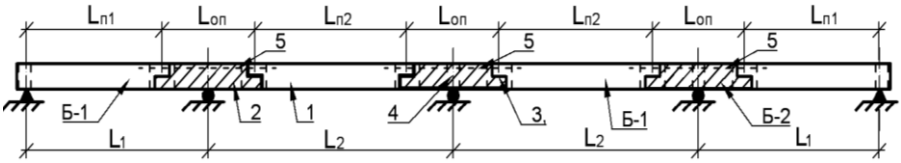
Схема розміщення збірних і монолітних головних балок в нерозрізній прогоновій будові моста: 1 - збірні в прогонах балки; 2 - монолітні або збірні балки над опорами; 3 - діафрагма у зоні стиків; 4- надопорна діафрагма; 5 – надопорна напружувана арматура
